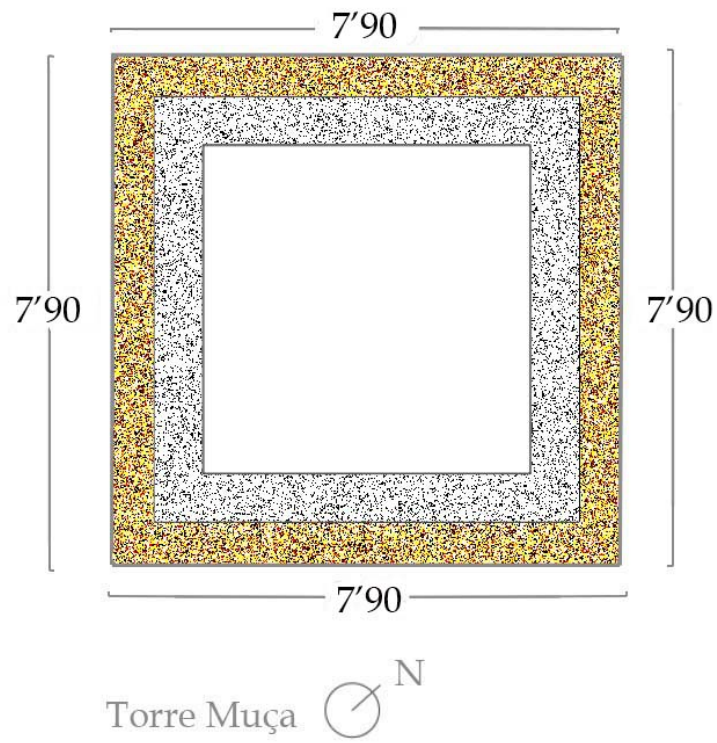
Planta de la torre de Muça (Benifaió). Elaboración propia.
